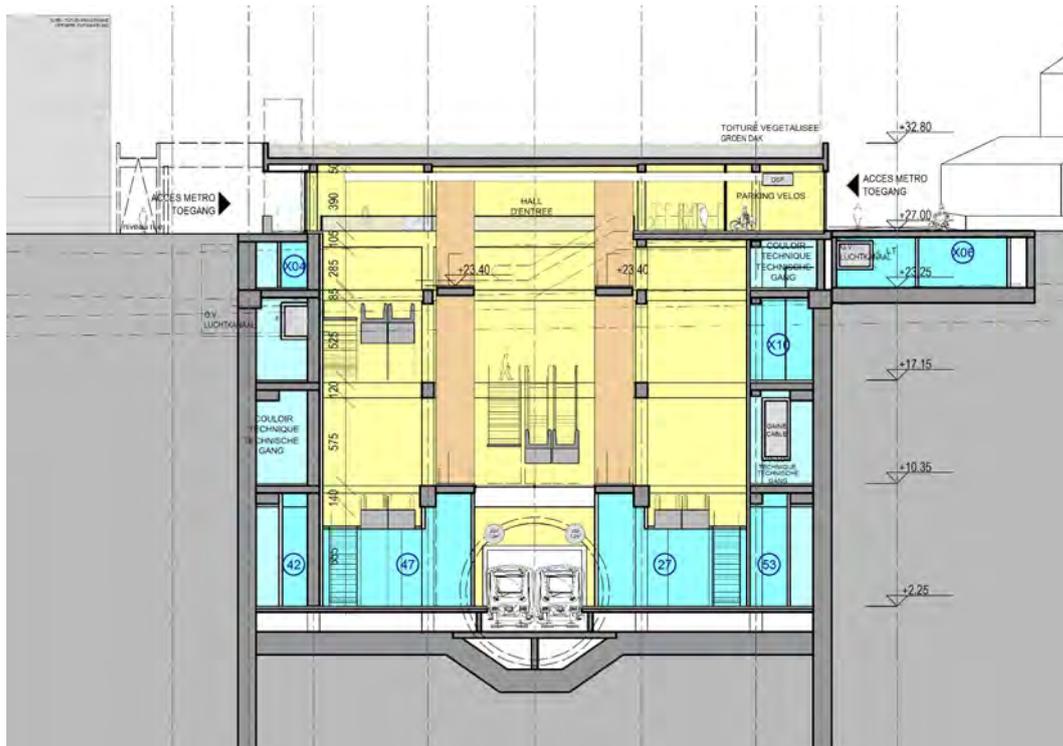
Station Verboekhoven, coupe transversale (BMN, 2018)
